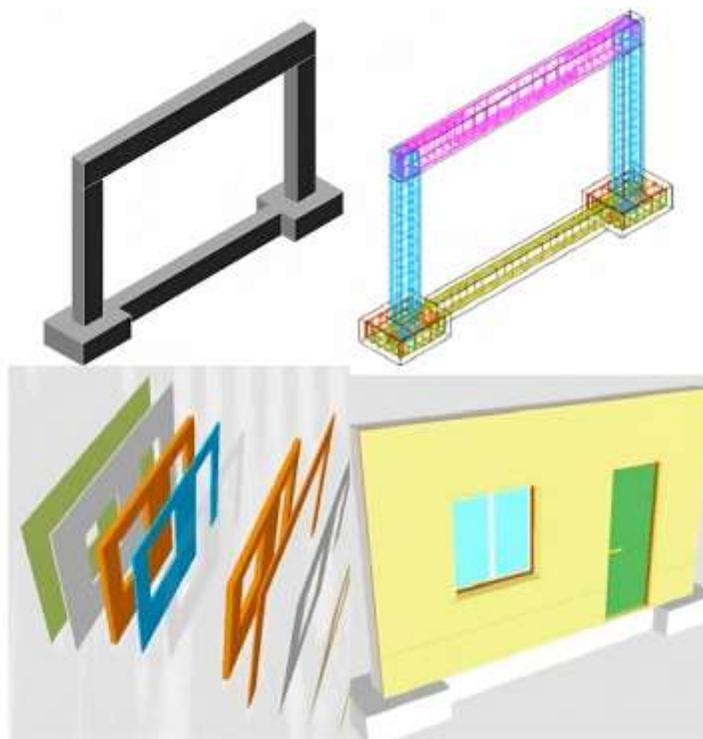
"Modelos 3D de refuerzos de acero de los elementos estructurales, los paneles verticales de relleno y las aberturas de puertas y ventanas."
